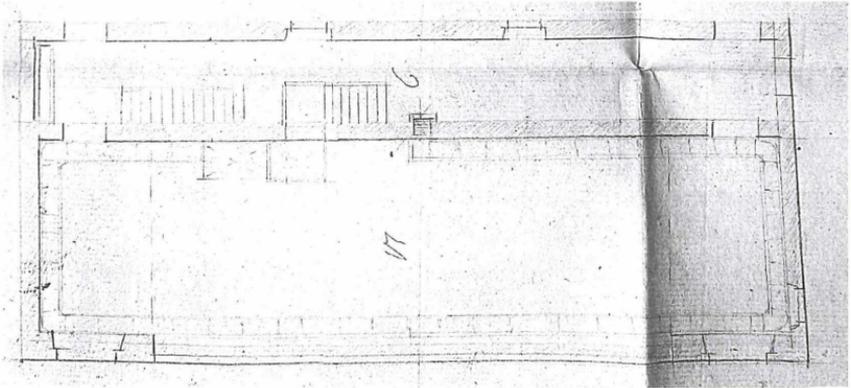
Grundriss des Aighofer Glashauses
